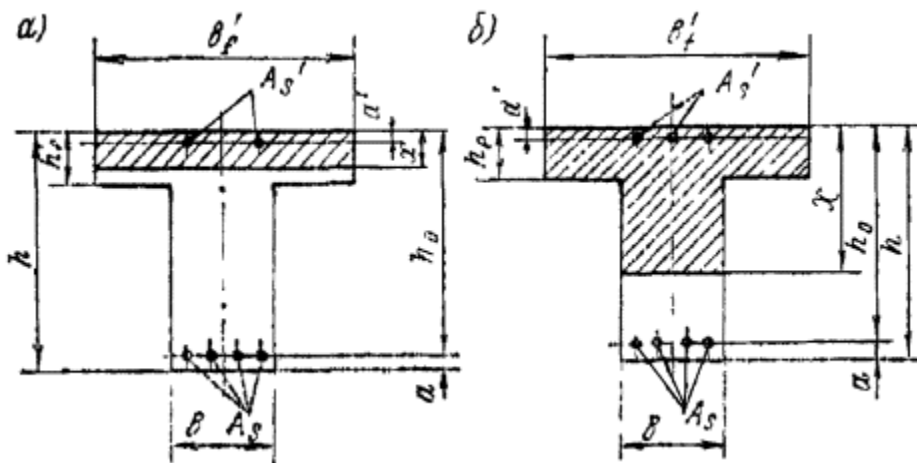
Форма сжатой зоны в поперечном сечении таврового железобетонного элемента со сжатой полкой
